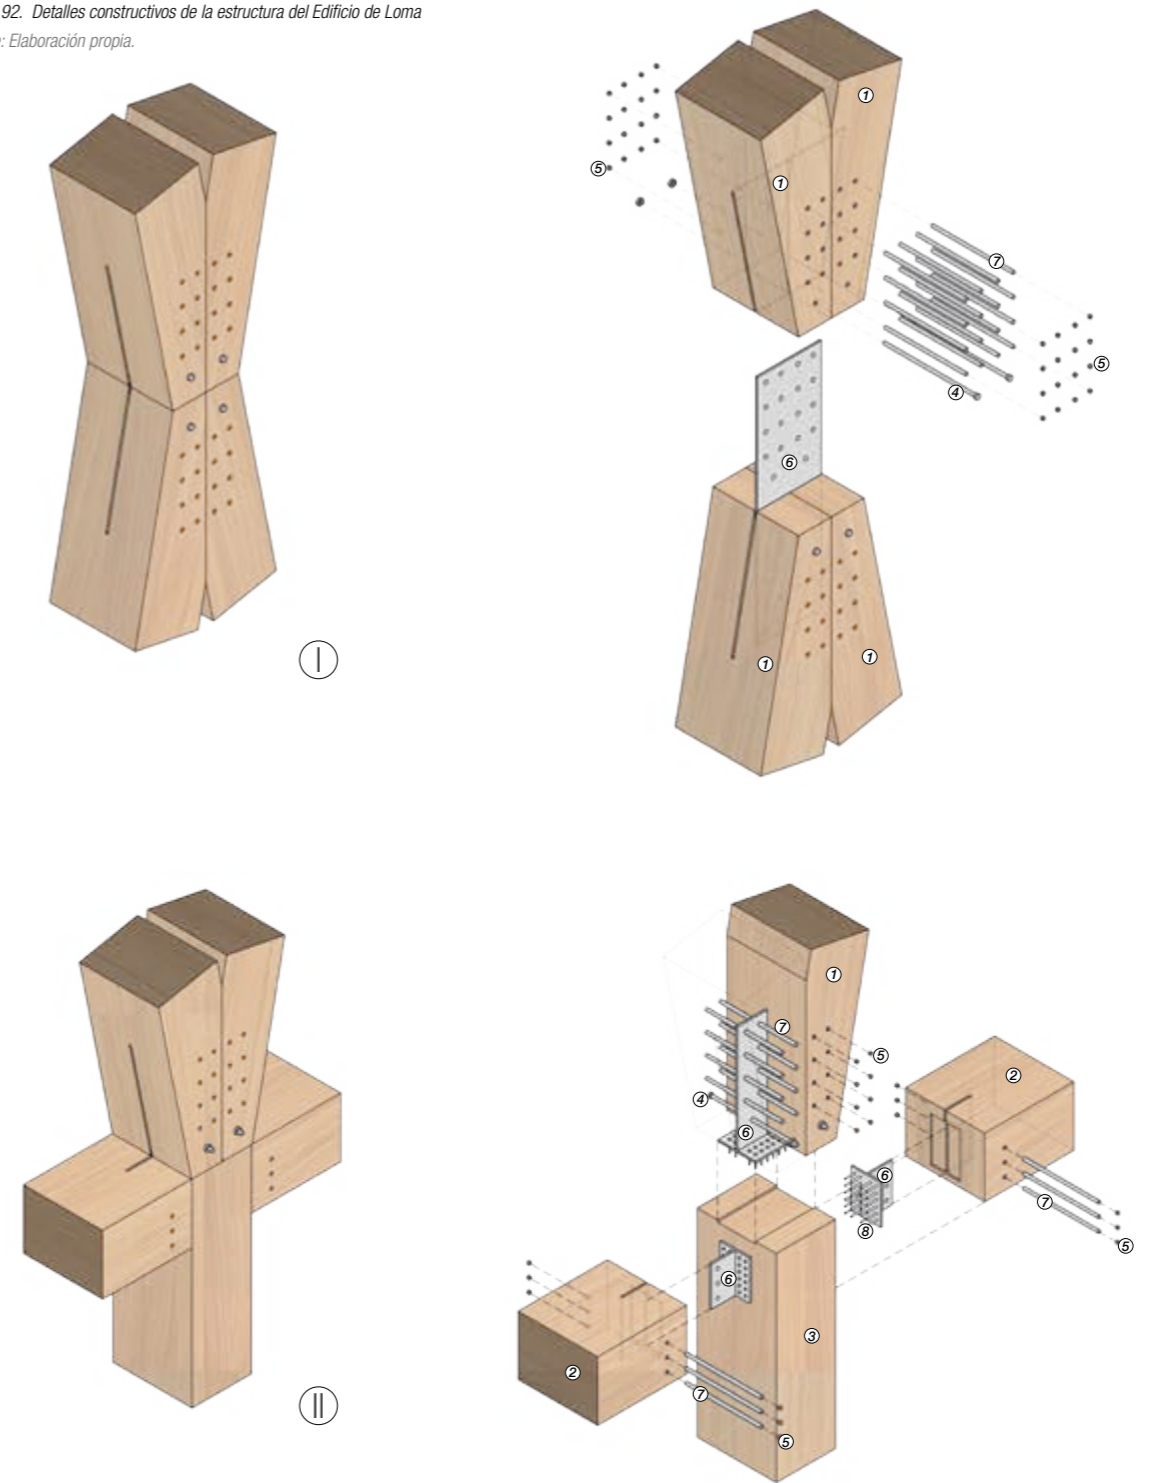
Detalles constructivos de la estructura del Edificio de Loma
